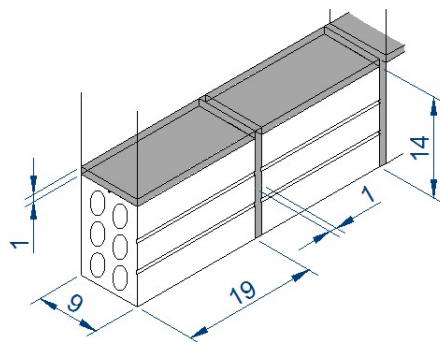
Detalhe do módulo para carregamento de alvenaria de 15 cm
